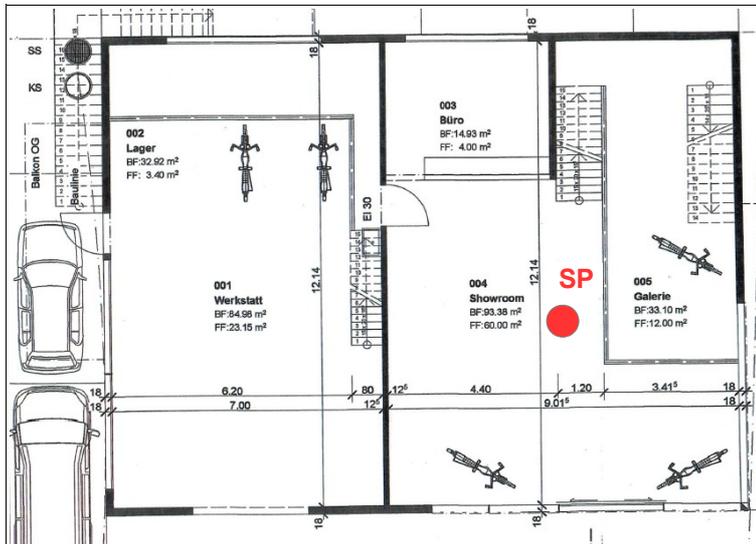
Grundriss EG, ohne Mst.; Quelle: Auftraggeber
